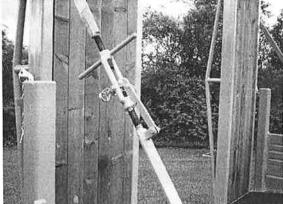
und 13: korrekte Sicherung der Stahlrampen
